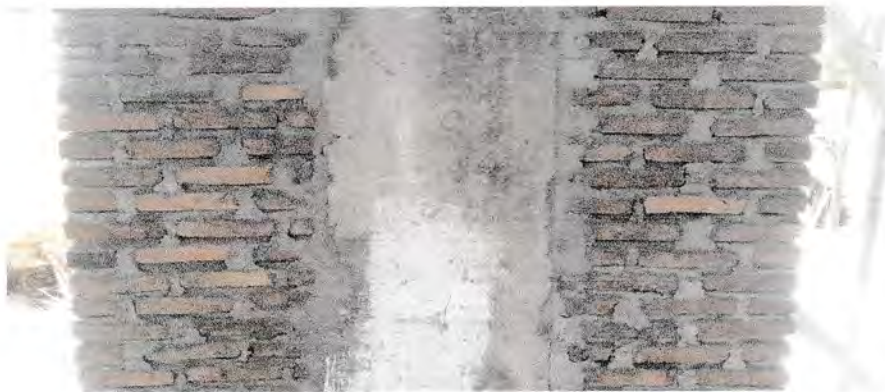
Pengerjaan sambungan Kolom dan Plat lantai
